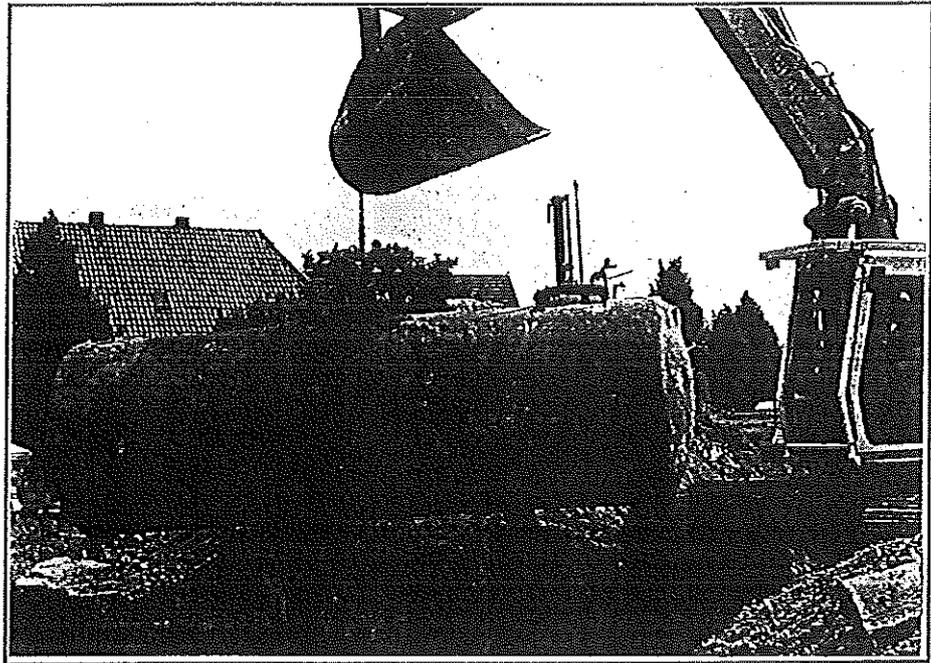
Teilansicht Sanierung ehemalige Betriebstankstelle, Erdtank
